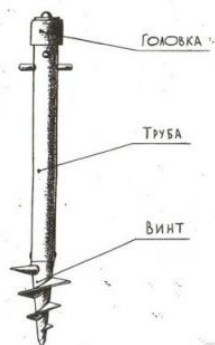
Внешний вид и схема конструкции грунтового опорного репера
